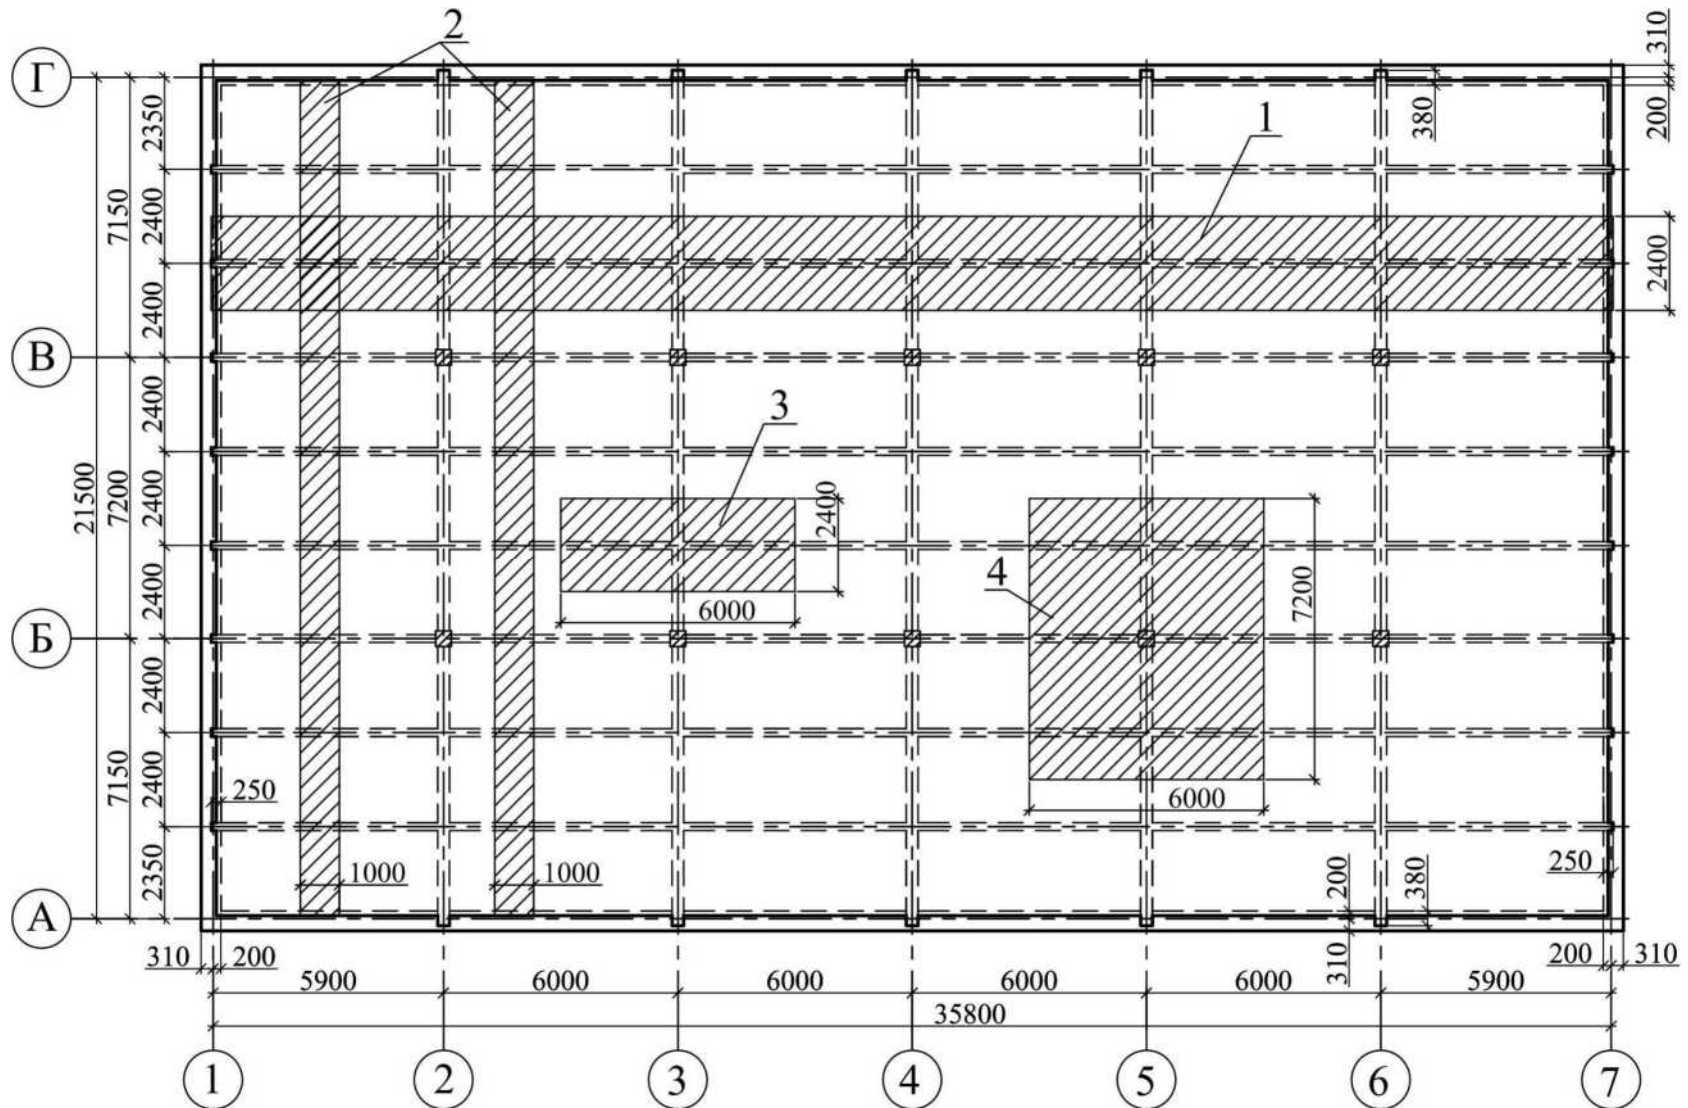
Вантажні площі елементів перекриття: 1 - вантажна площа для розрахунку другорядної балки;
